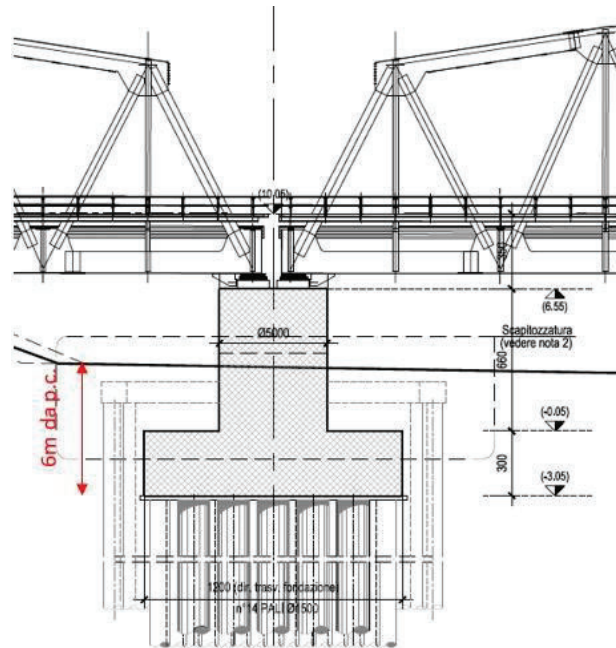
Schema della pila di fondazione posta ad una profondità di 6m dal p.c.
